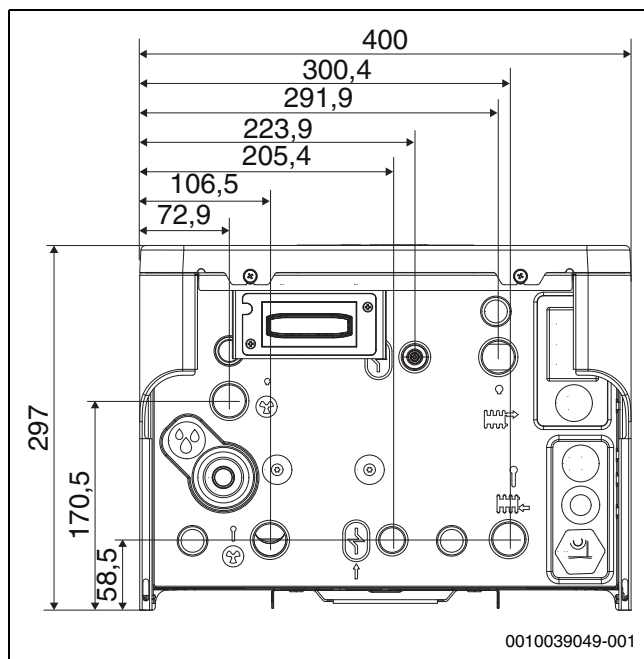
Dimensioni collegamenti, vista dal basso (mm)
